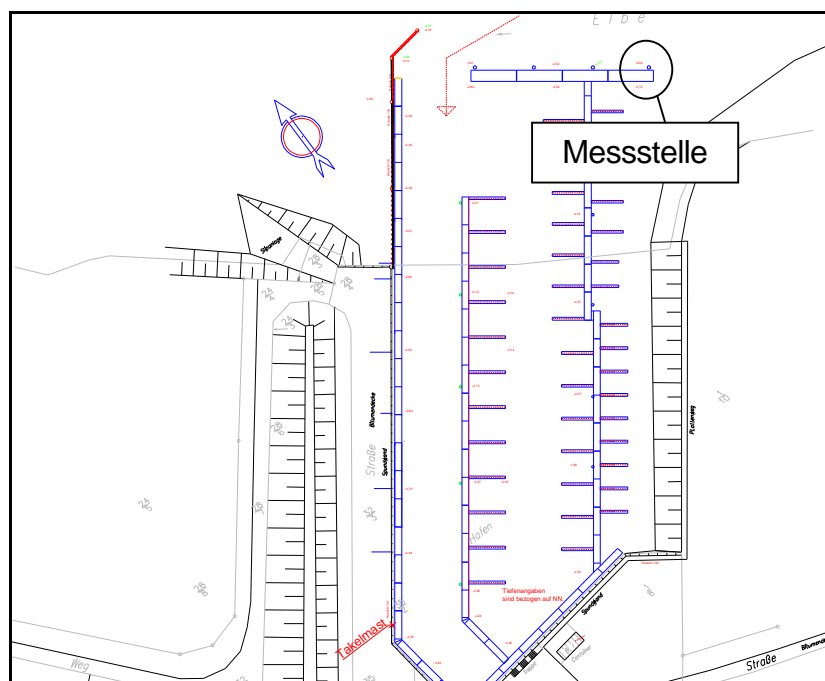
Lageplan des Jachthafen Neuenschleuse mit Darstellung der Messstelle
